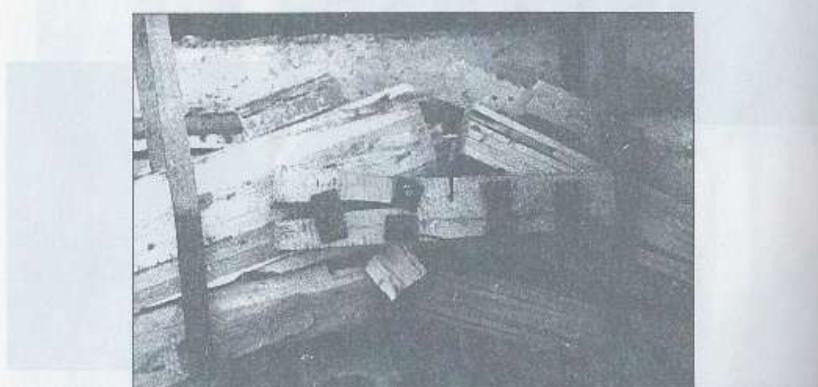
Разрушение прямолинейных клееных блоков при испытаниях металлодеревянных арок типа МДА
